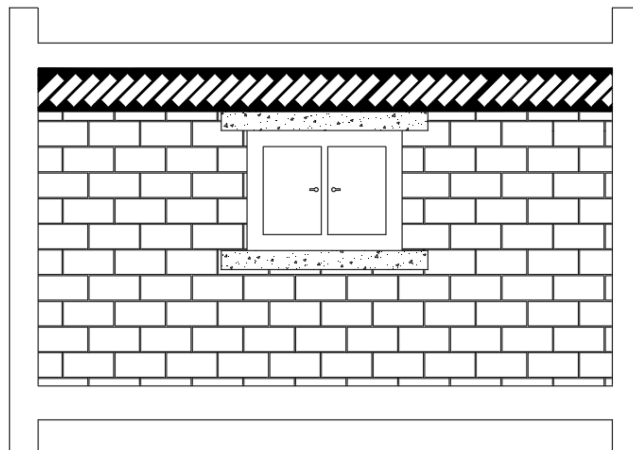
Encunhamento entre alvenaria e viga executado com tijolos de barro cozido. Fonte: adaptado de (THOMAZ, FILHO, *et al.*, 2009).
